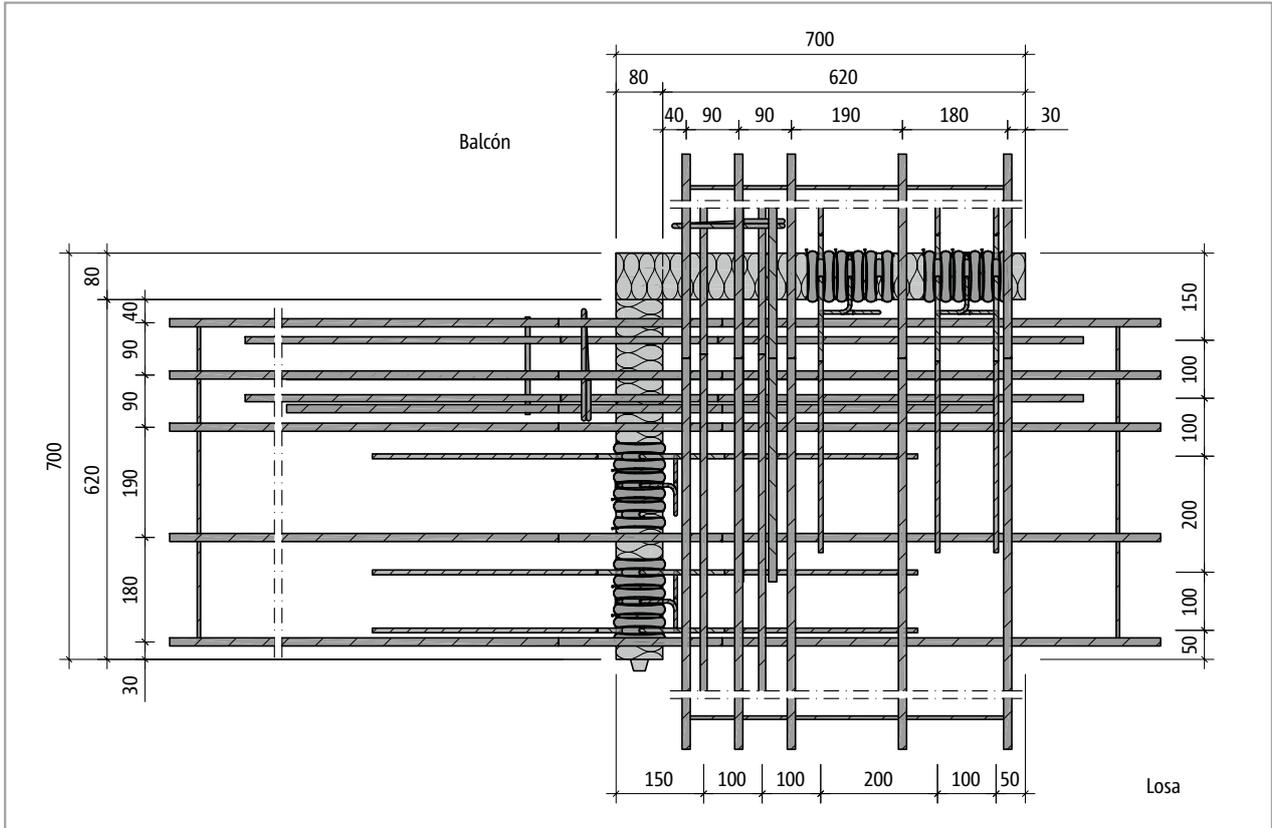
Schöck Isokorb® T tipo C-M2: Plano del producto
